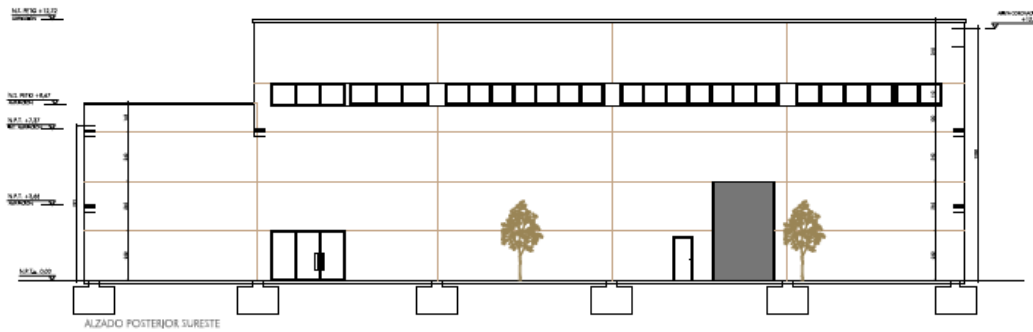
Alzado posterior sureste. Fuente: Arhotek
